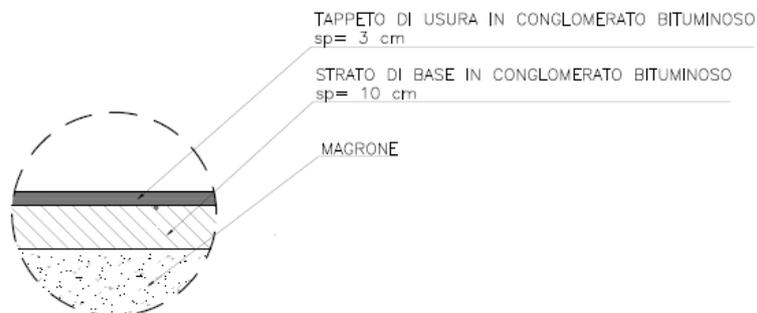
Pacchetto di pavimentazione zona pedonale
